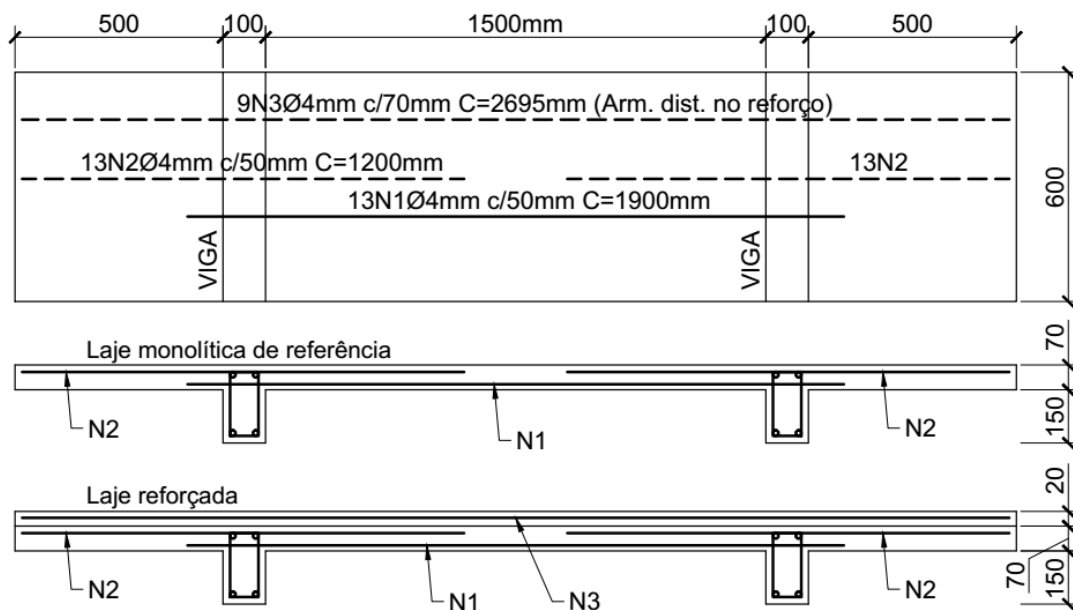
Detalhamento das lajes ensaiadas (AYKAC *et al.*, 2016).
